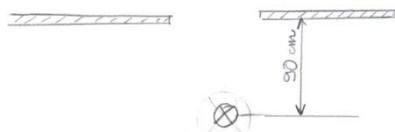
Placement si la porte est grande ouverte ou coulissante
